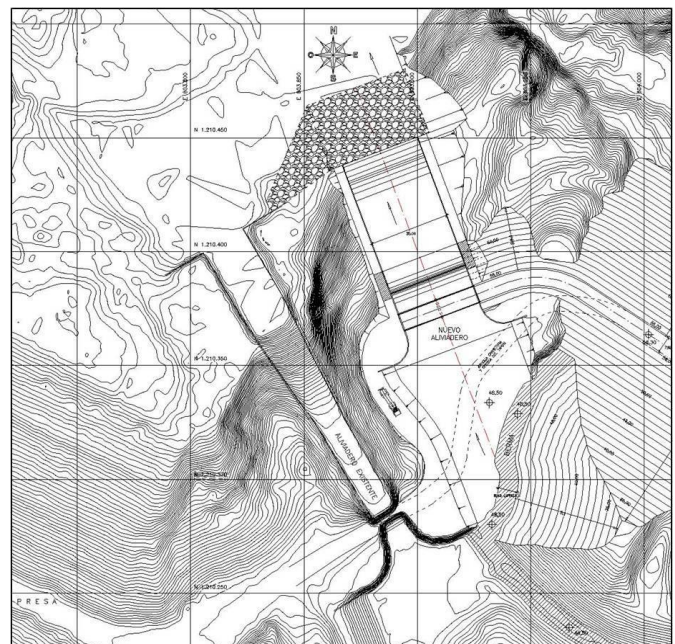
Ubicación en Planta del Nuevo Aliviadero, Complementario del Existente
